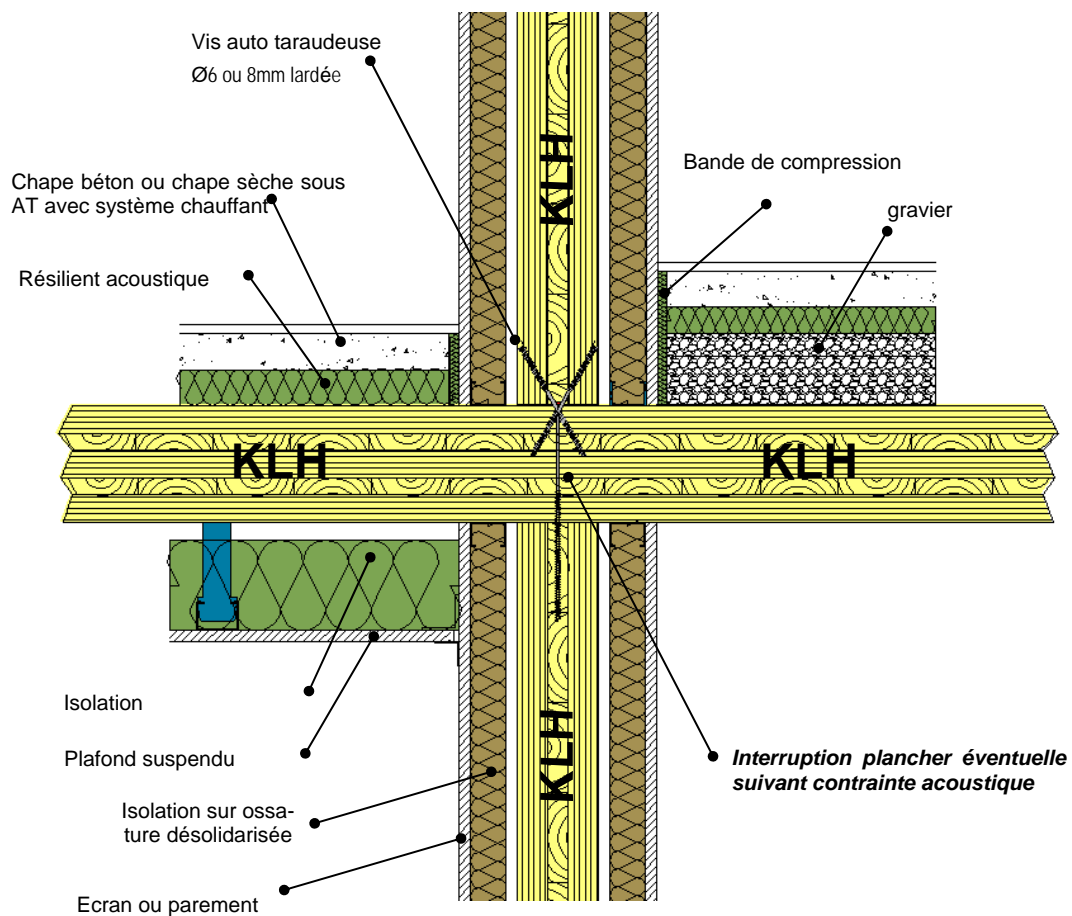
Coupe verticale sur locaux mitoyens et superposés avec plancher filant
